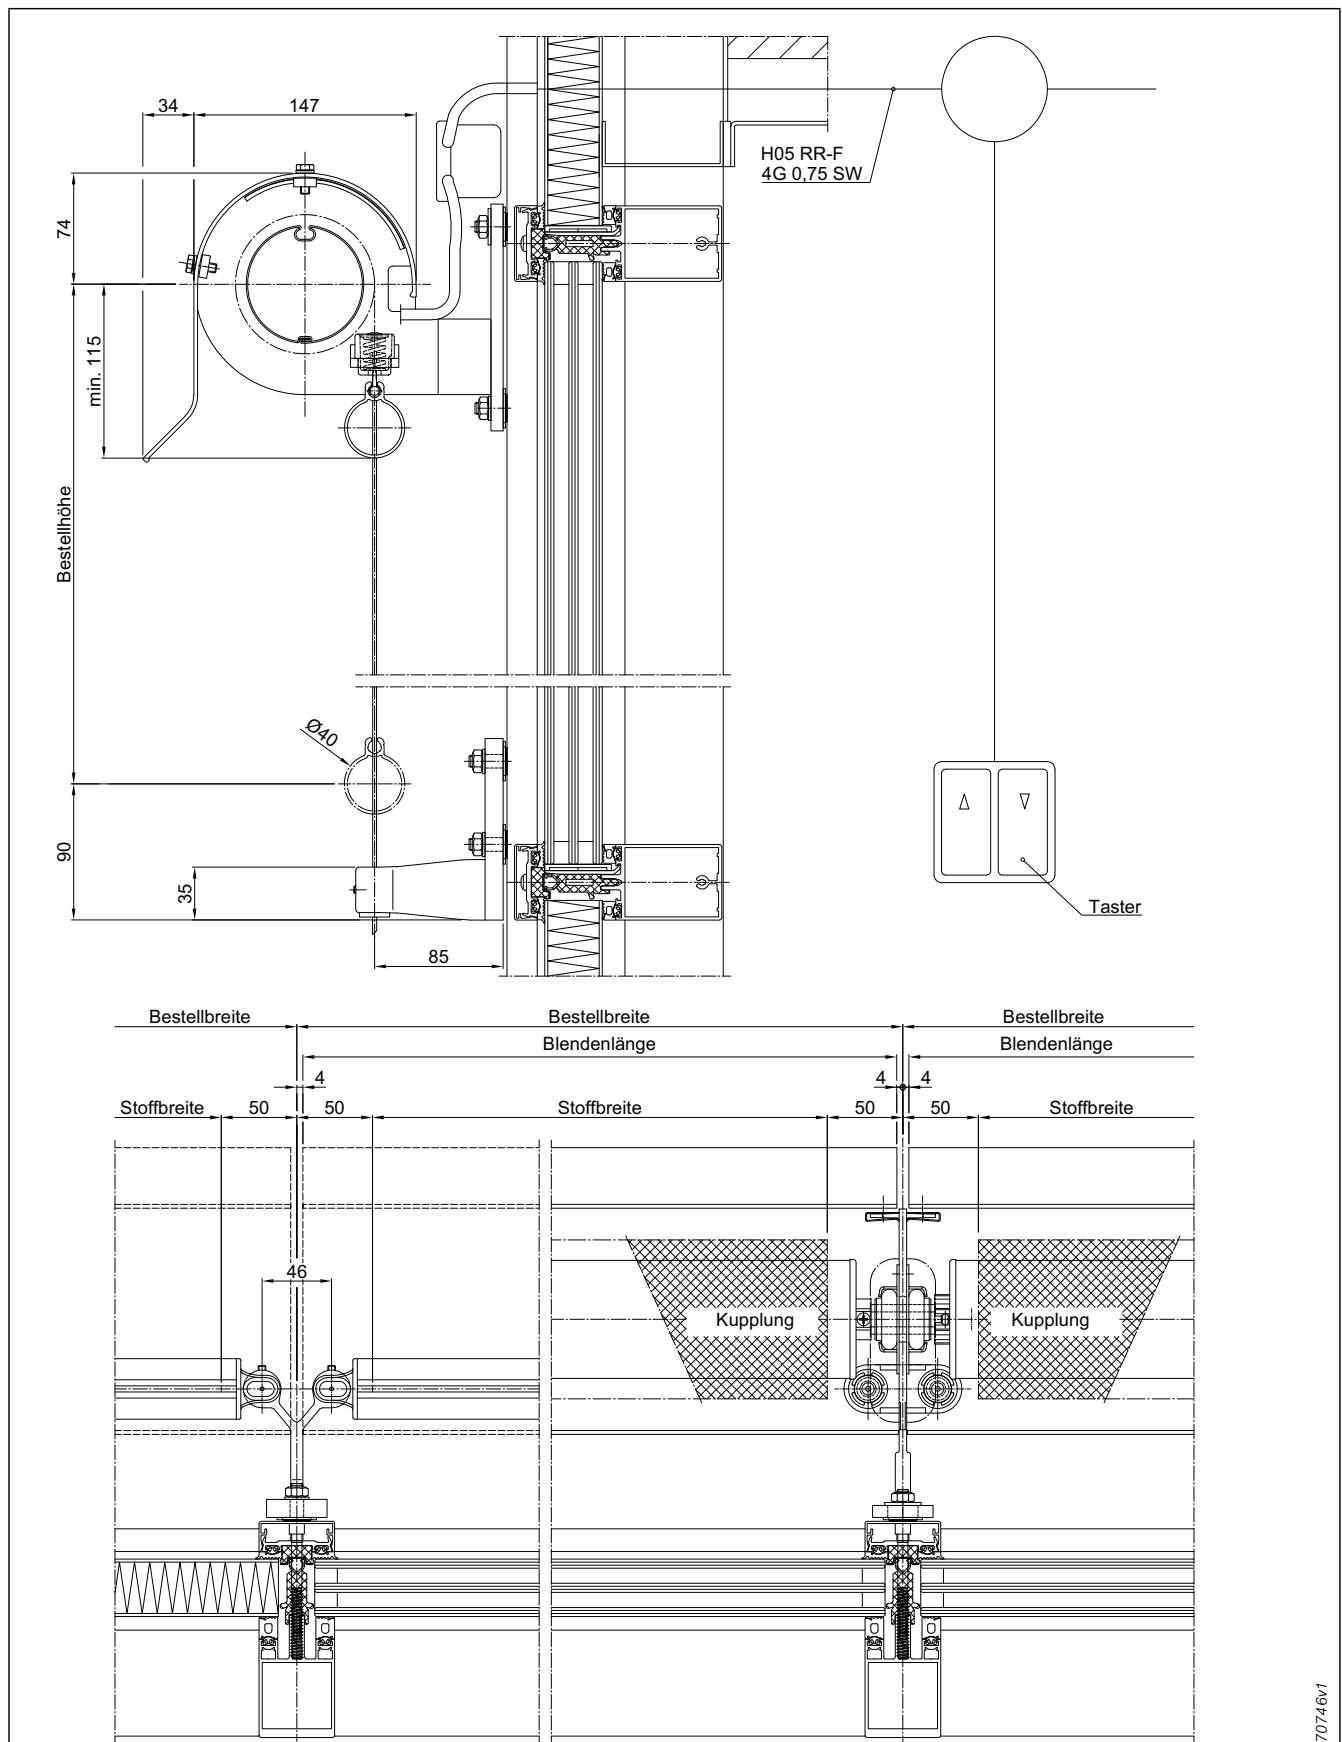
Fassaden-Markise 207 mit Halbrundblende Typ 2.3
